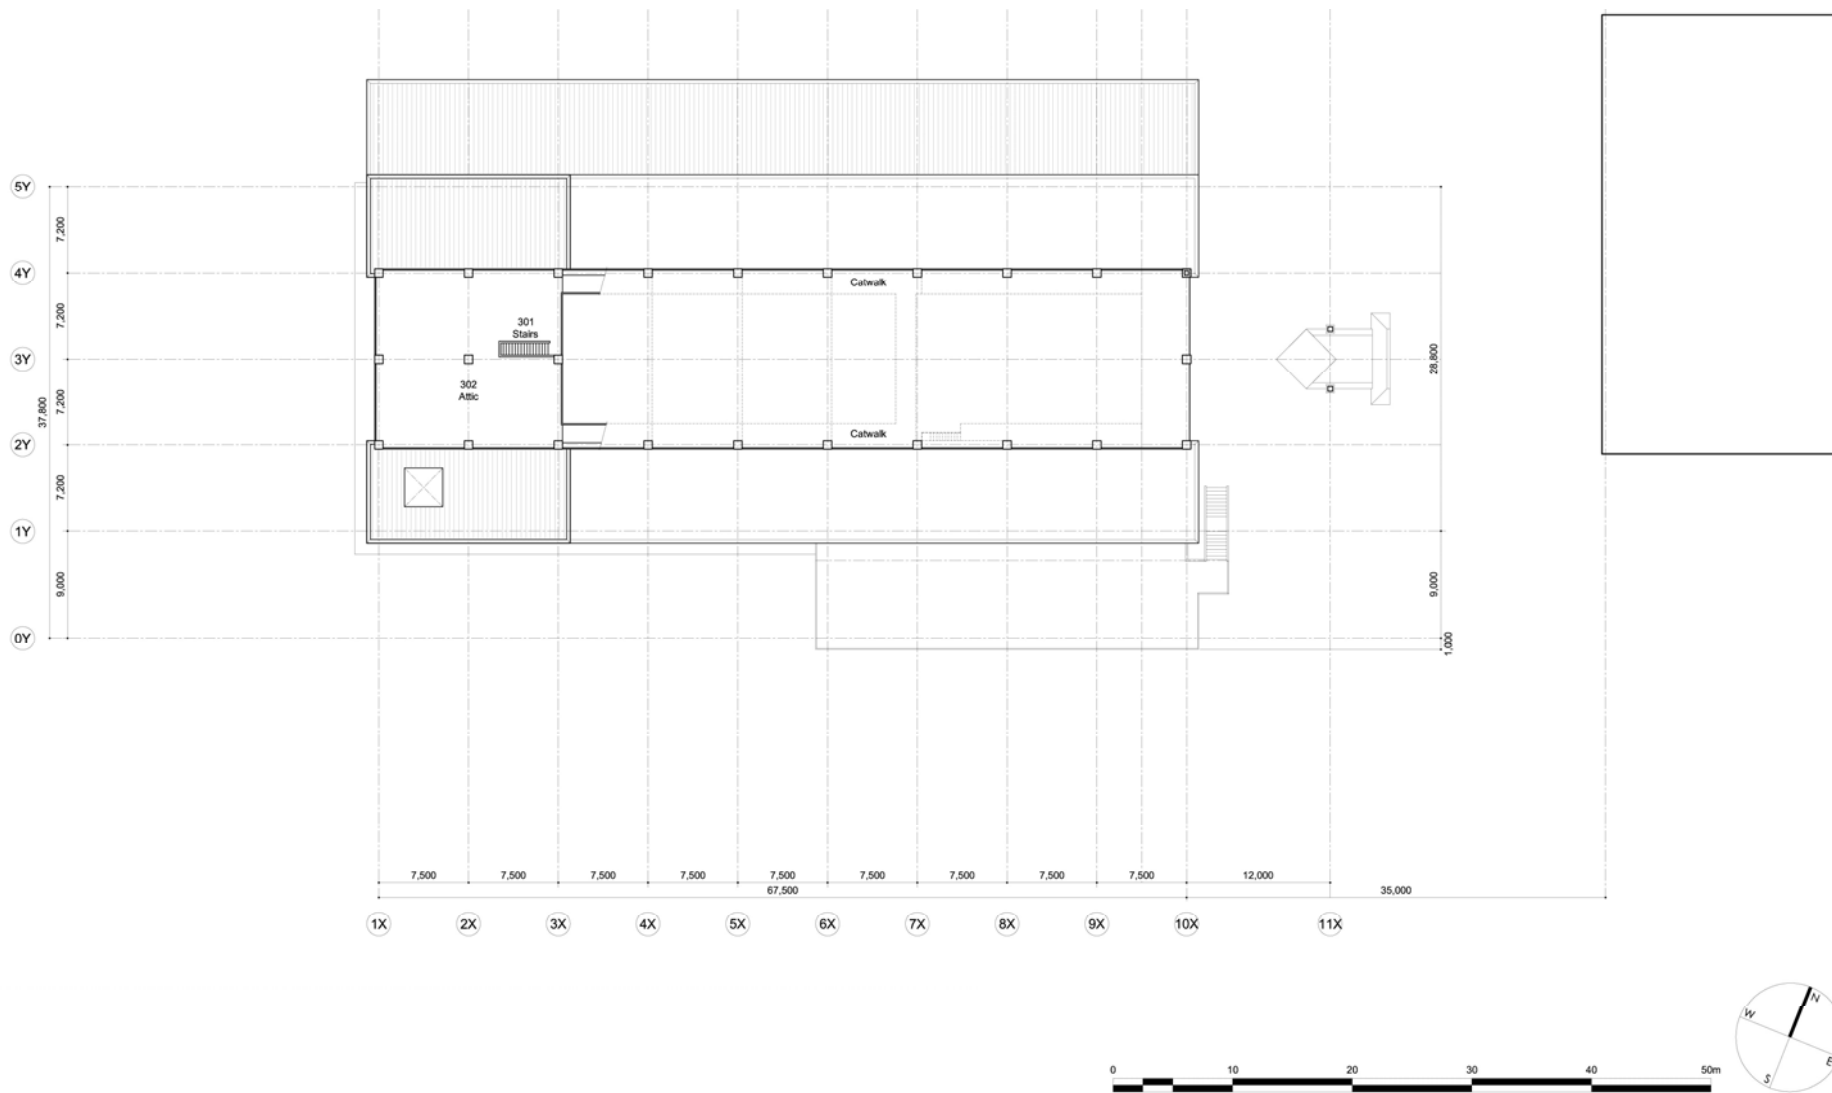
国際線出発ターミナルビル (IDT) 屋根裏平面図
